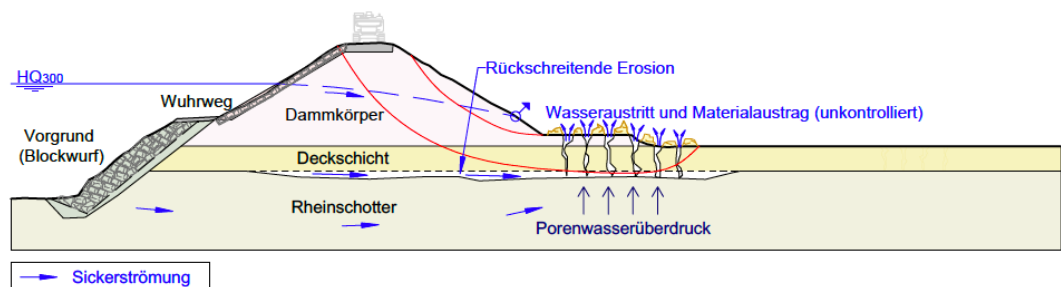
Schematischer Querschnitt Dammaufbau mit Sickerströmungen und hydraulischem Grundbruch
